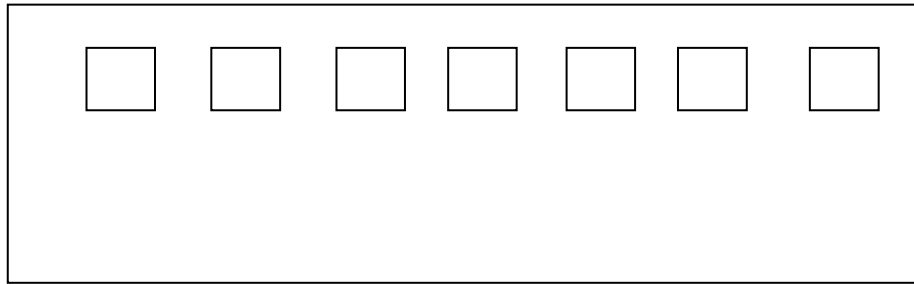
Surfaces des ouvertures sur la façade secondaire
